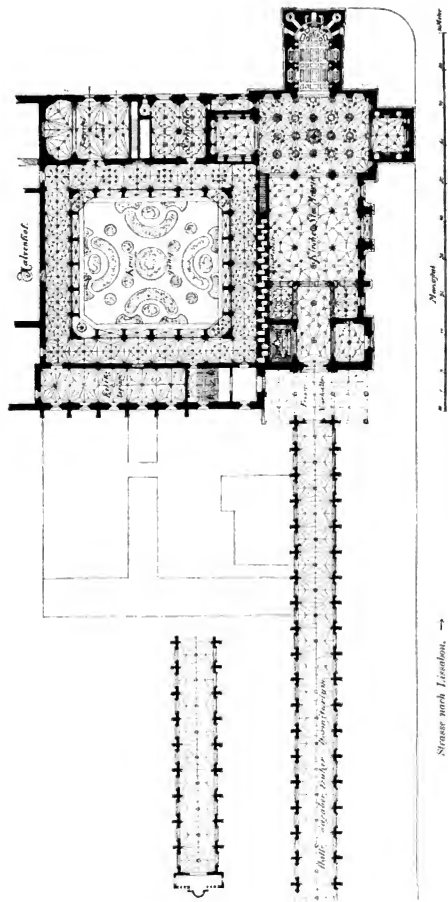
Grundriss des Klosters des Hieronymos zu Belem.
